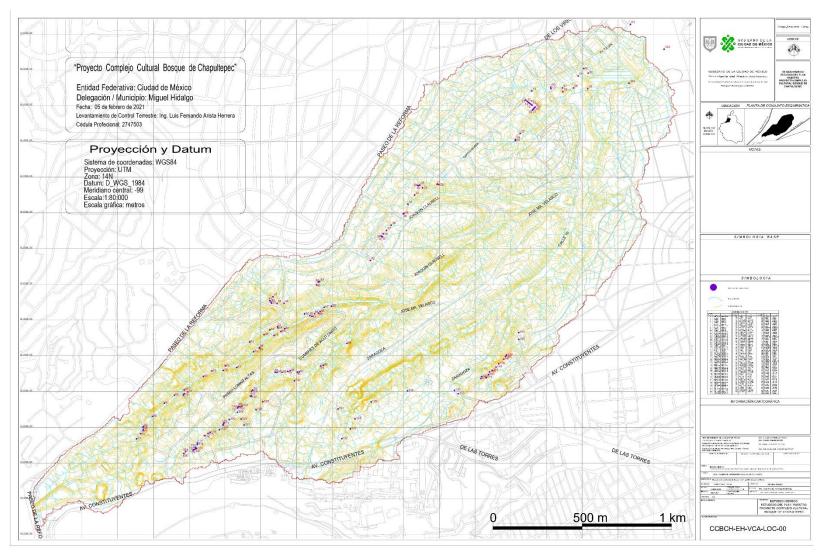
Plano de localización de zona de vertedores/conexión albañal sistema.
